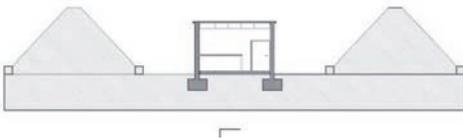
Sección de detalle constructivo de almacén con defensas de protección.
